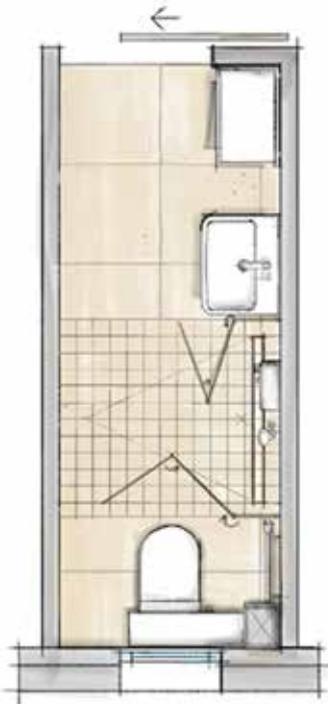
„Best of“ der Grundrissvarianten zum Schlauchbad (Grundrisse: DLW)
